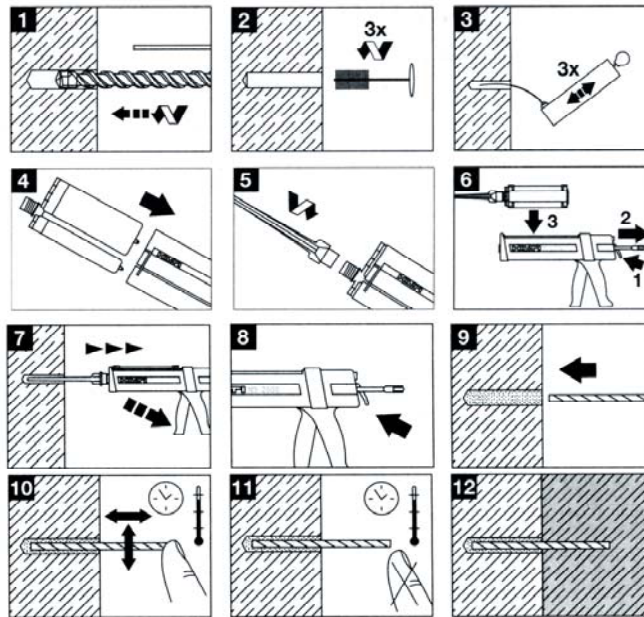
Montageanleitung eines Herstellers zum Installieren eines Bewehrungsanschlusses mittels Injektionssystem (aus Hilti Handbuch der Befestigungstechnik)
